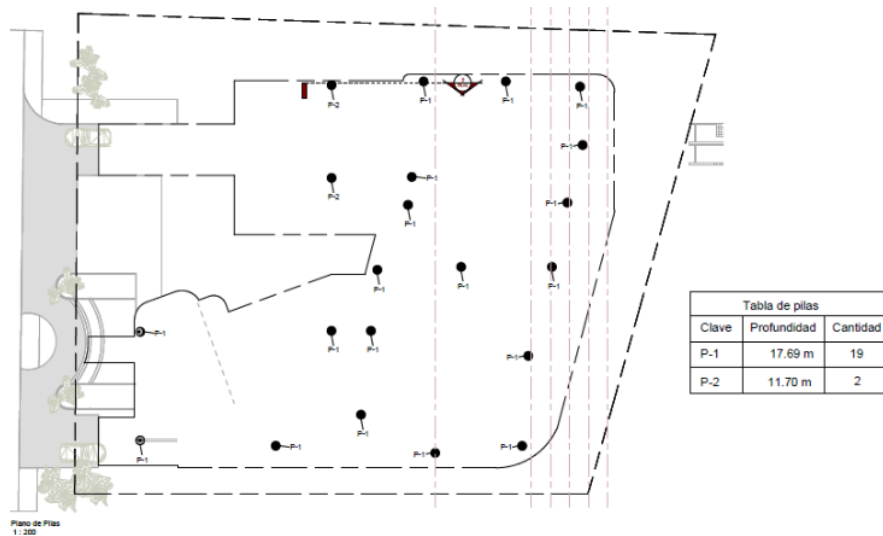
Ubicación de las pilas que se pretenden en el proyecto.
